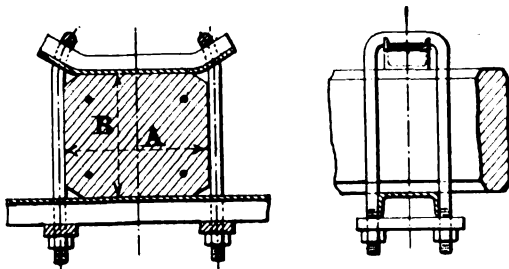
Schéma d'assemblage des traverses sur poteaux rectangulaires (Matériel Mahaut).
